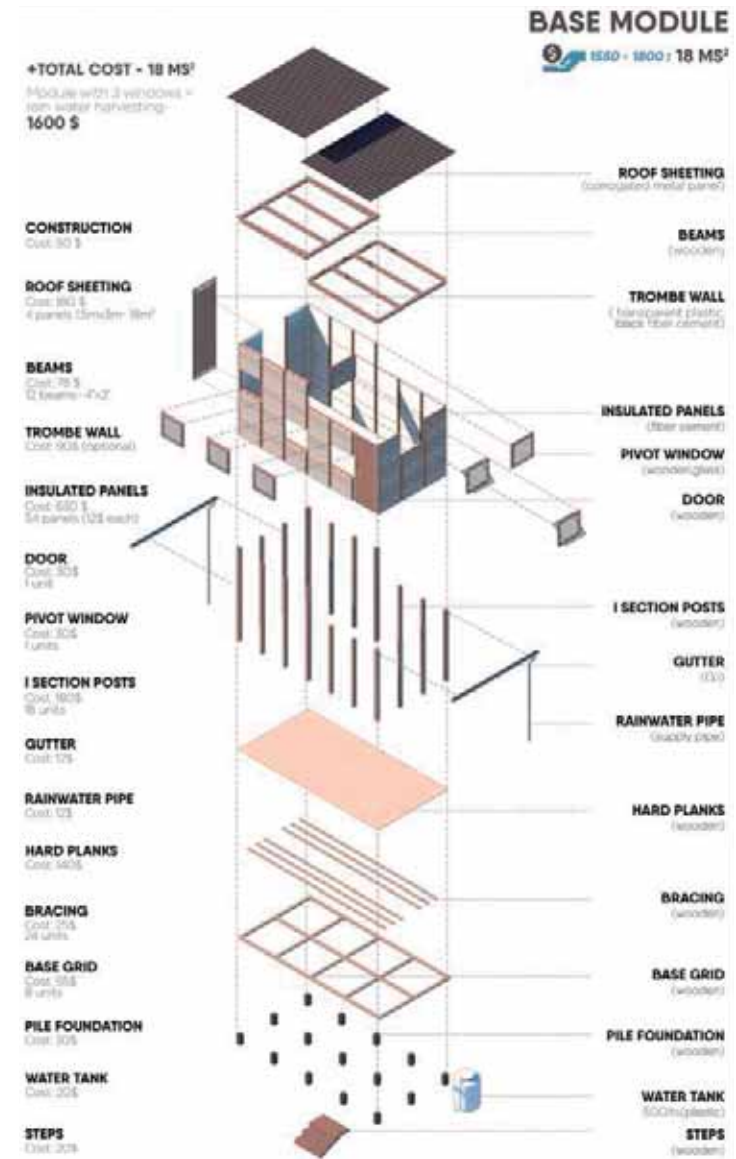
Componentes del sistema constructivo de MODPOD. Autores: Abhiram Dileep, Shubham Dudhoria, Suryans Goya. Fuente: Archdaily.
